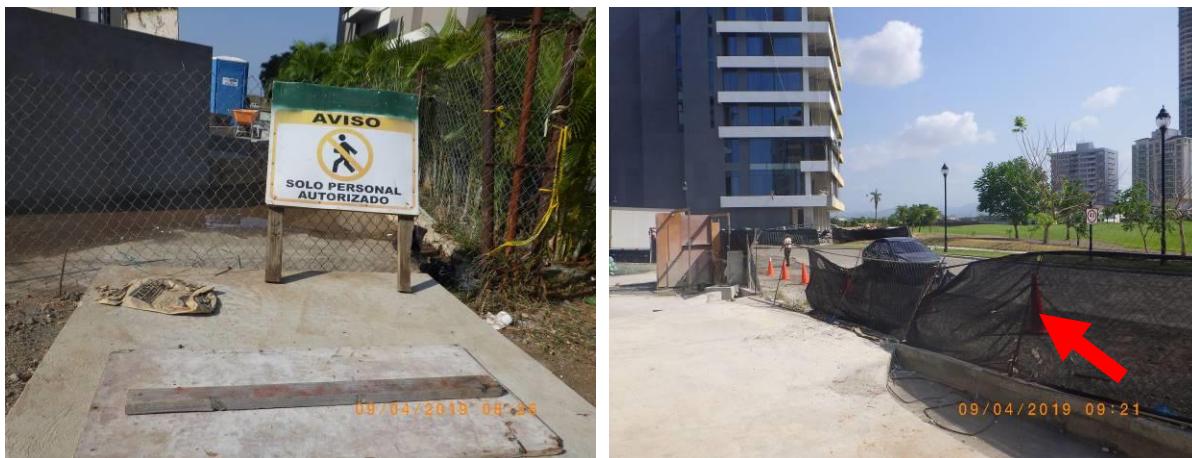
Vista de la rejilla de drenaje pluvial, cubierta por material de construcción
